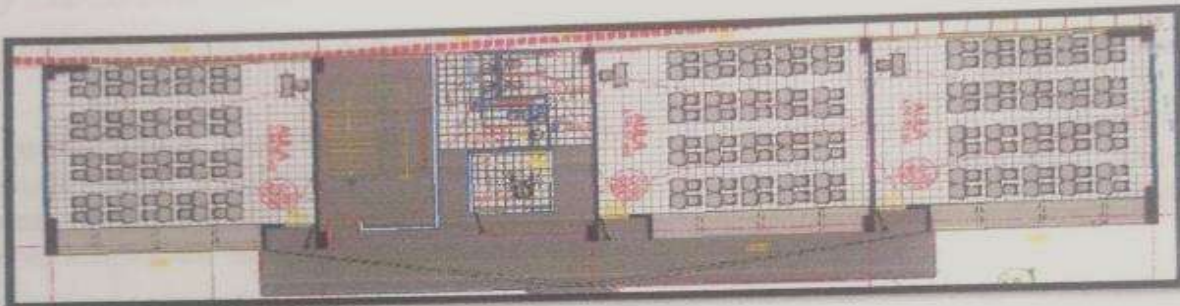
Planta del primer al cuarto nivel Modulo C.
